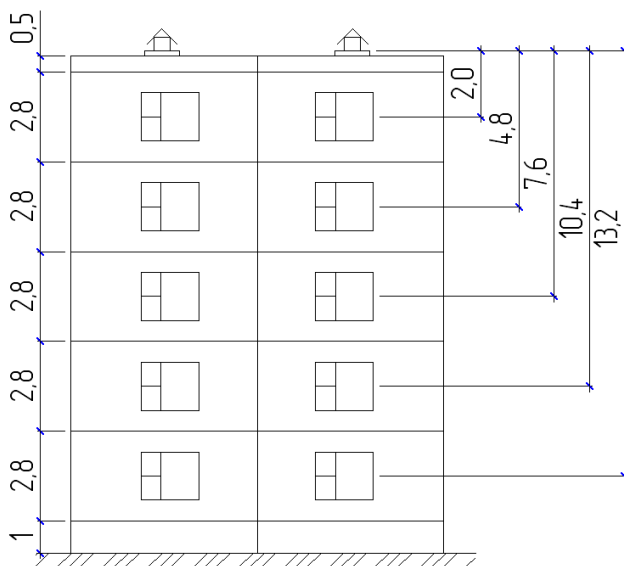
Пятиэтажный крупнопанельный жилой дом
